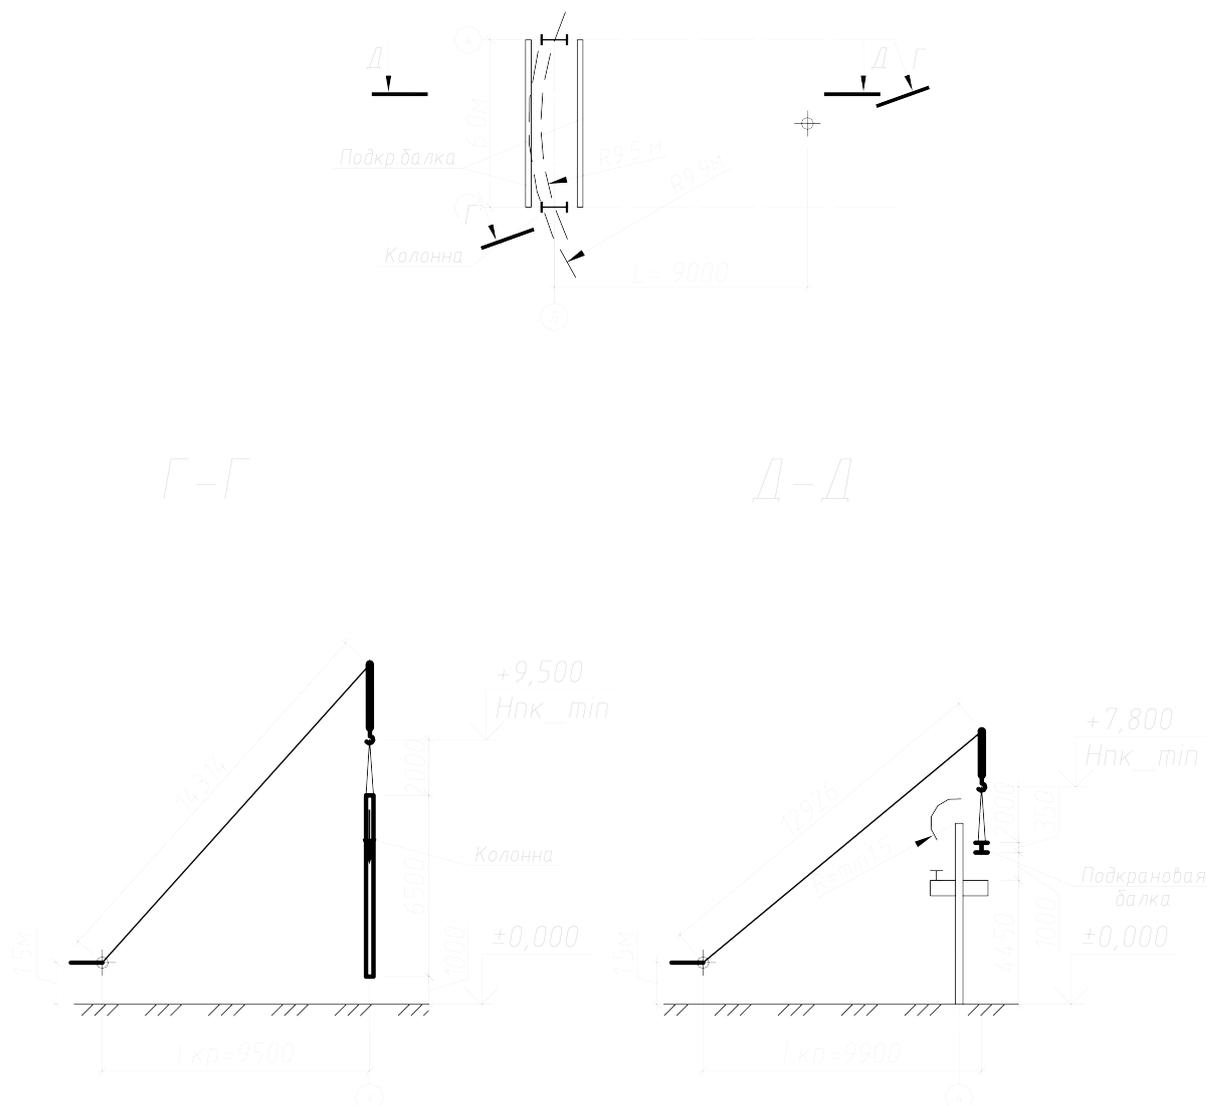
«Определение вылета стрелы и высоты подъёма крюка крана графическим методом при монтаже ферм (разрез Г-Г) и подкрановых балок (разрез Д-Д)» [2]
